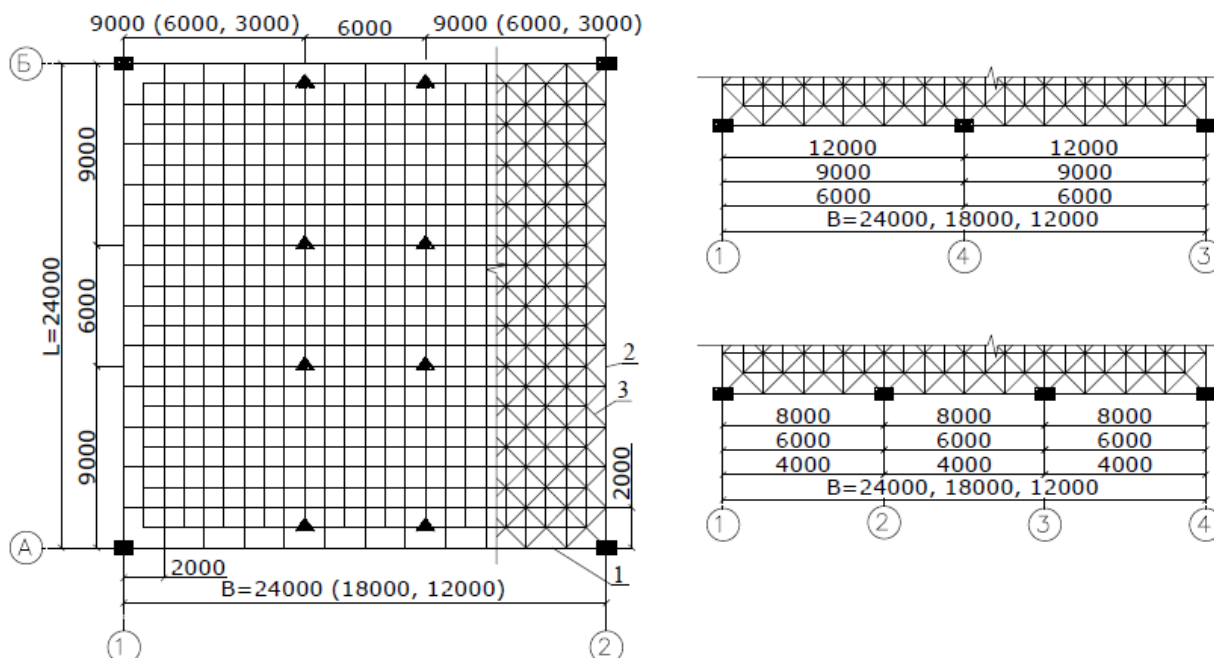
Расчетная схема с указанием мест приложения крановой нагрузки
